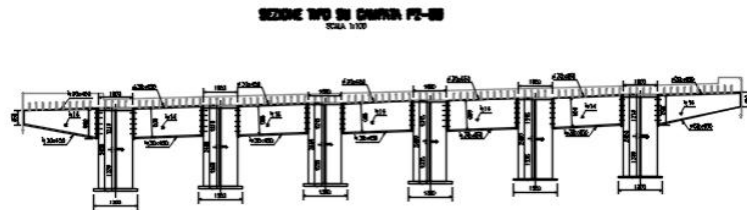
Struttura impalcato - Sezione trasversale tra pila P2 e spalla SpB
